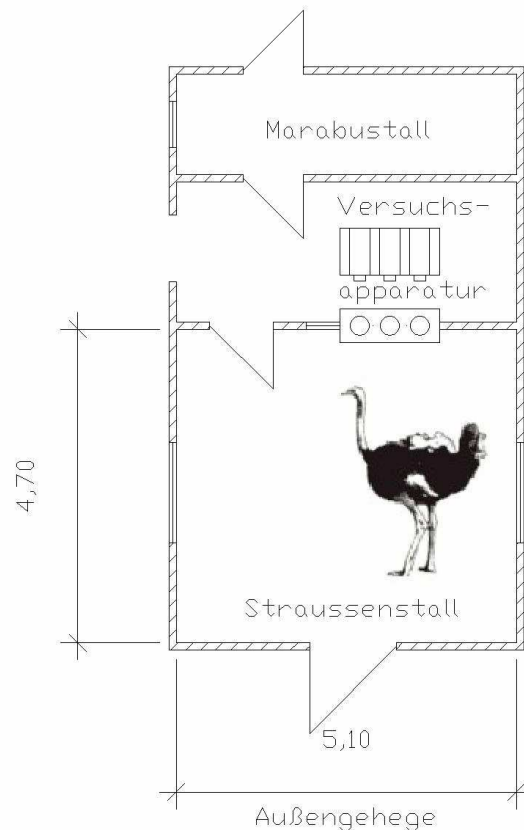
Grundriss Stallgebäude mit Versuchsanordnung
